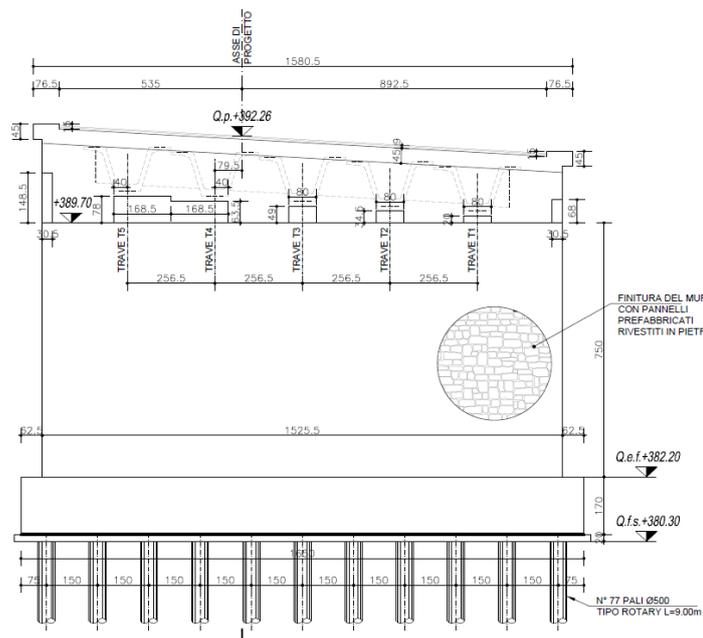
VISTA FRONTALE SPALLA SP2 VIADOTTO FOSCO BRILLI
